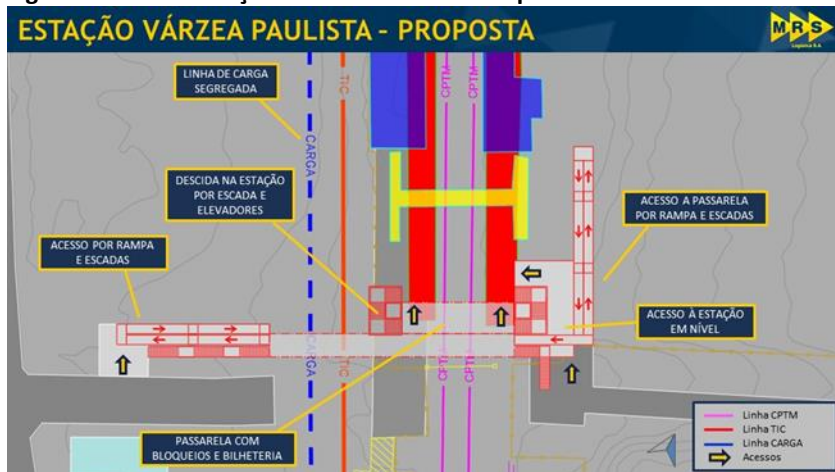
Nova Estação Várzea Paulista – Proposta - Planta
